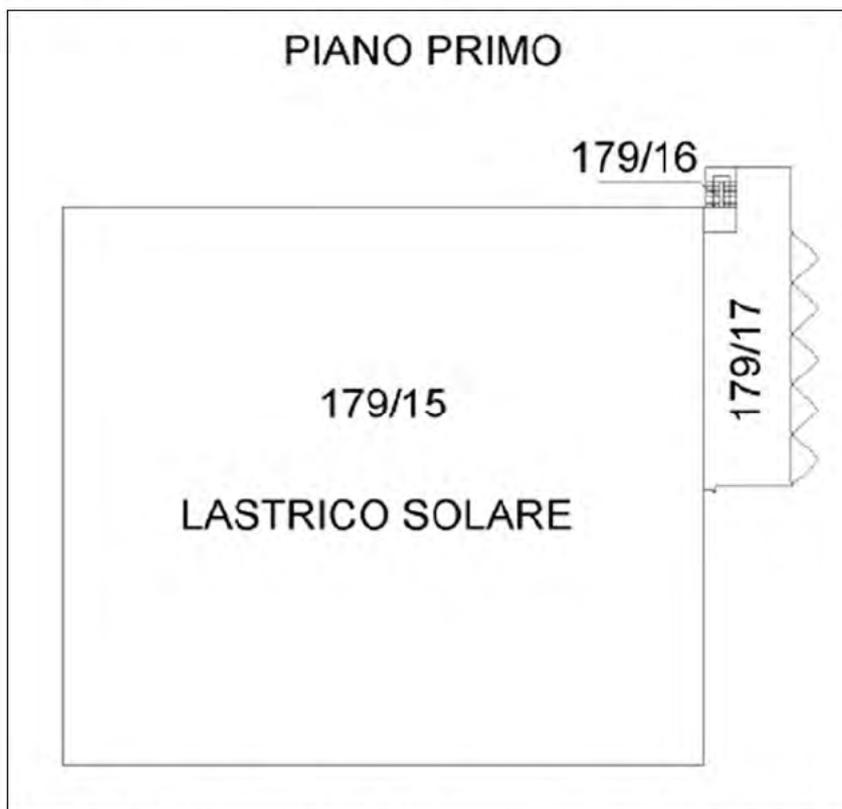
estratto del piano primo dell'elaborato planimetrico catastale della particella 179
